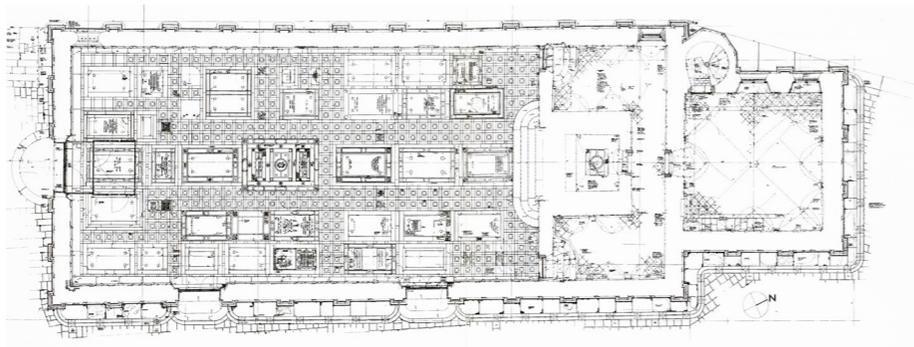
Pianta della chiesa (M. Lpnitz, R. Geiger)
